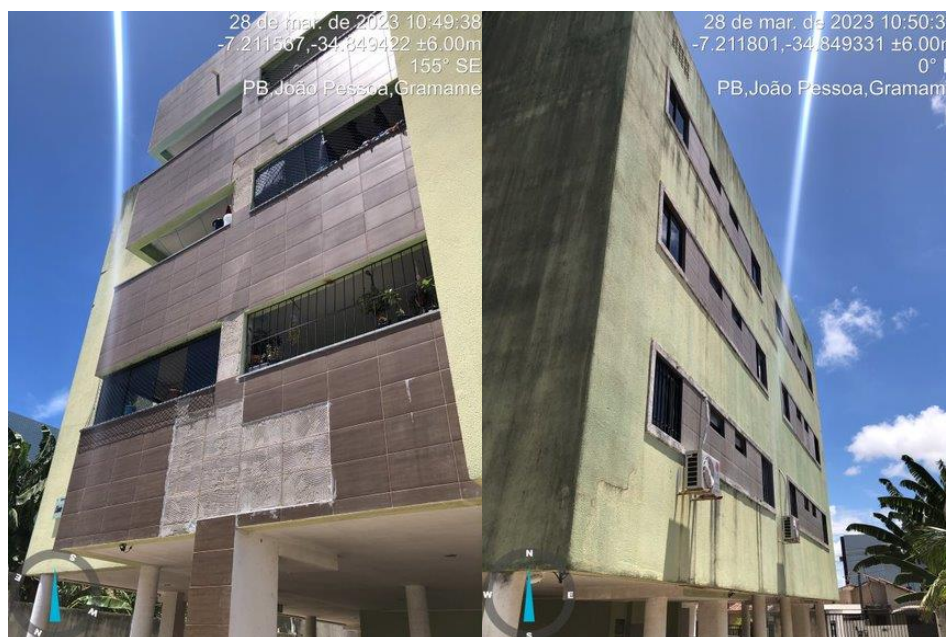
Fachada com ausência de junta de dilatação/movimentação
